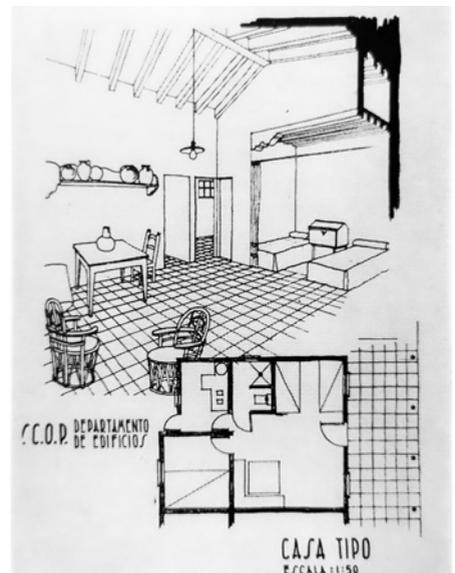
Croquis en planta y perspectiva de un proyecto para casa campesina. Fuente: Katzman (1964: 86).
